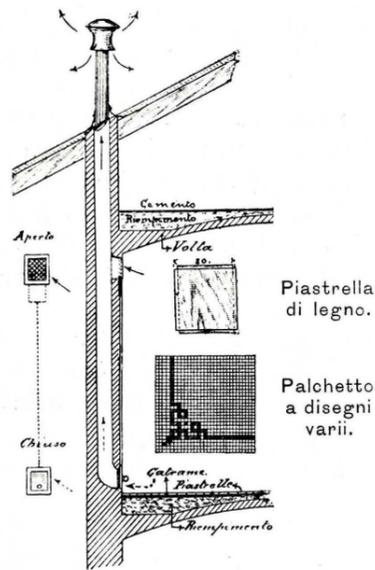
FIG. E. — Sezione verticale di un canale di ventilazione, delle volte e dei pavimenti.
